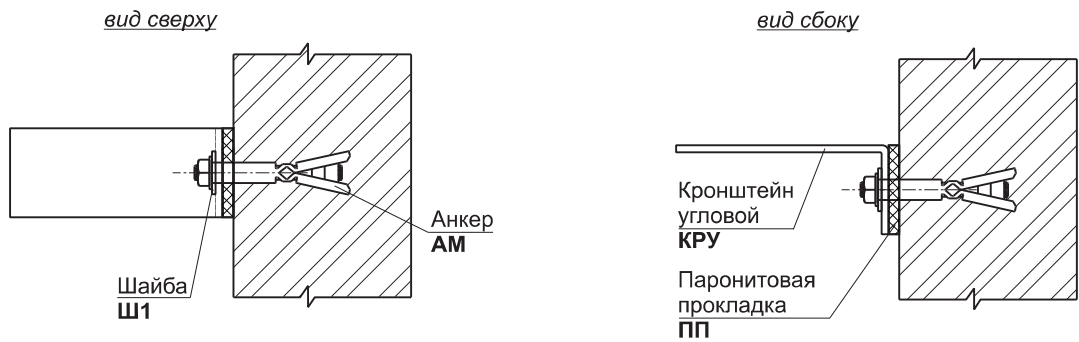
Узел крепления кронштейна КРУ к стене.
